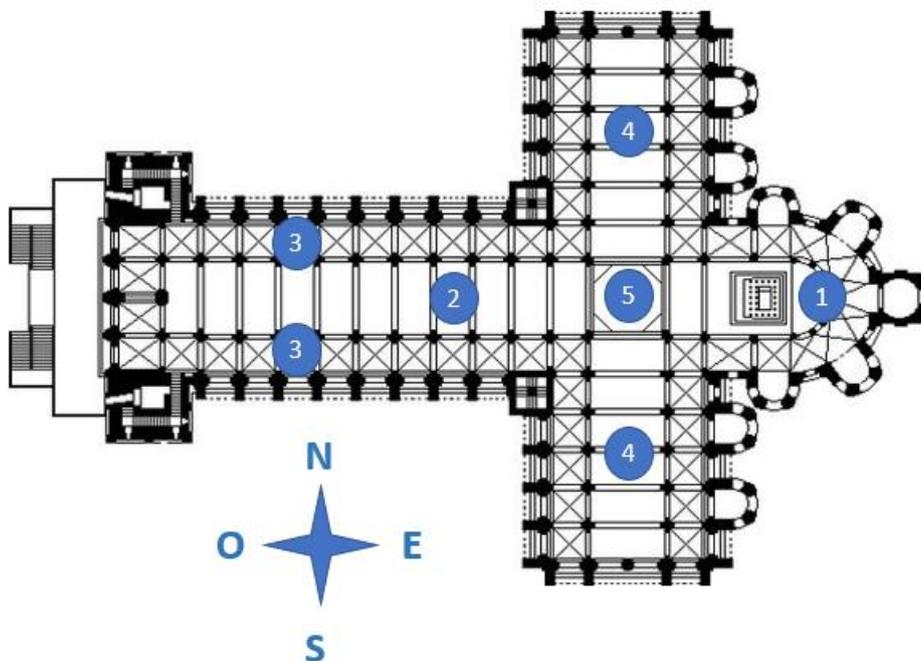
Planta de una catedral en forma de cruz Latina. 1) Brazo oriental o coro (altar mayor); 2) Nave central (oeste); 3) Naves laterales; 4) Transeptos norte y sur; 5) Crucero
